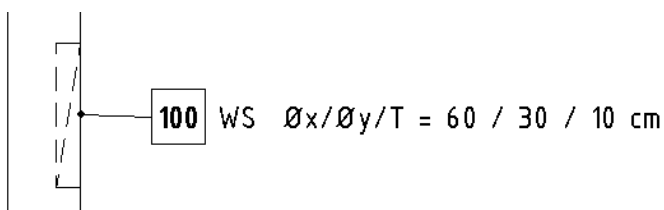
Darstellung eines Wandschlitzes inkl. Beschriftung
